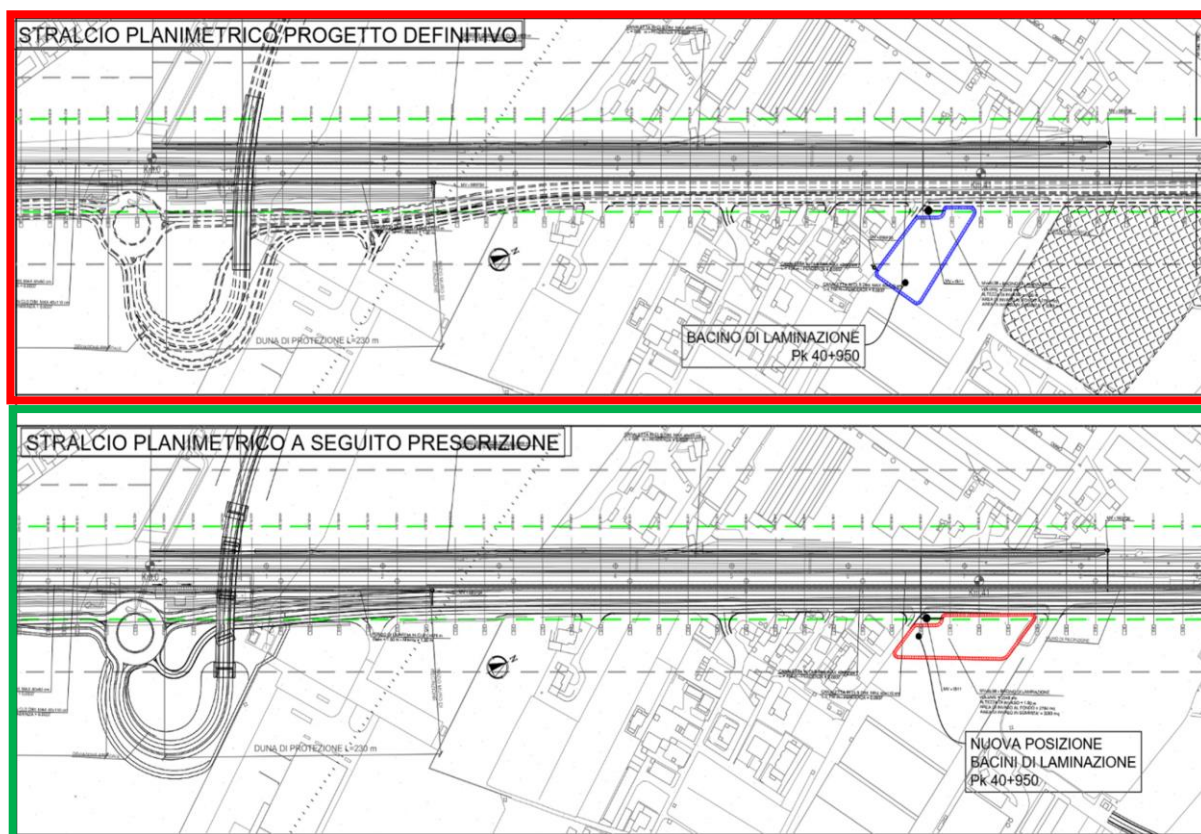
Confronto planimetria PD (rosso) PE (verde)
